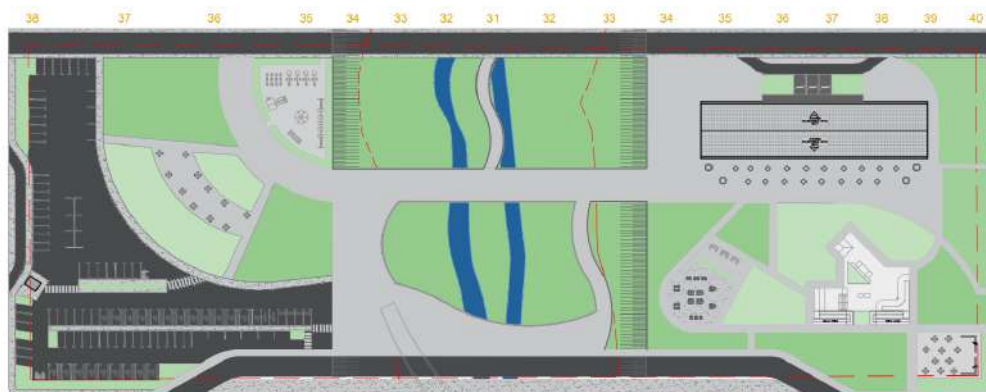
Implantação da Praça, Fonte:Acervo da autora.
